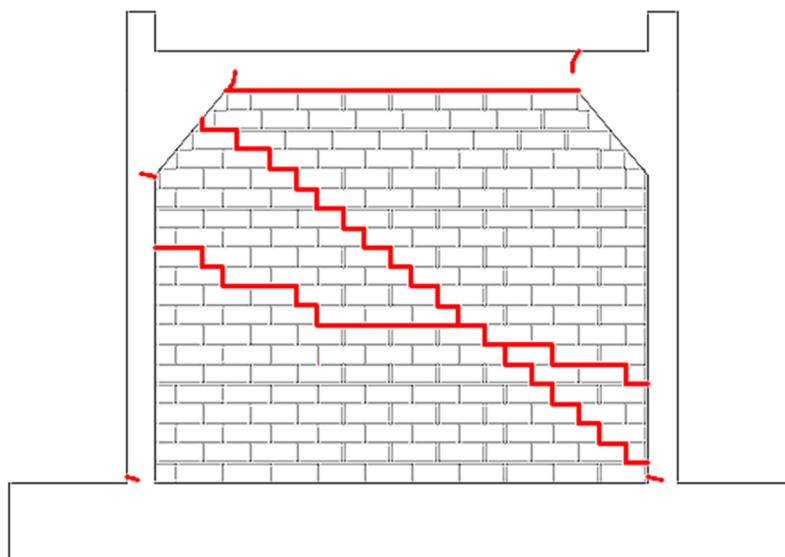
36: Expérimental : - Fissures aux pieds des deux poteaux. Fissures à la tête du poteau gauche, Petites fissures verticales aux extrémités de la poutre supérieure, Fissure diagonale dans le panneau en maçonnerie. ($\delta = 6.00$ mm, drift = 0.3%).
